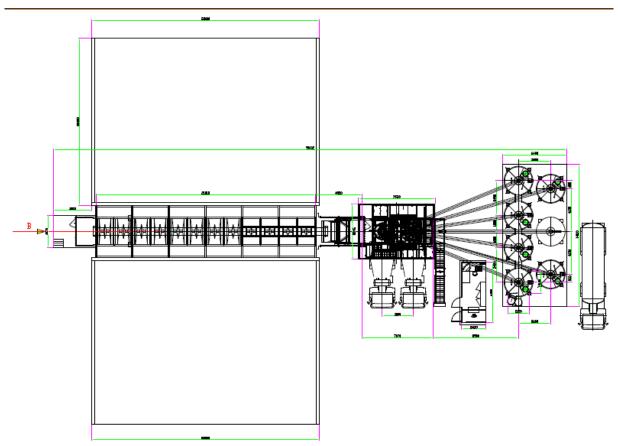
Vue en plan de la centrale à béton (document LIEBHERR)
